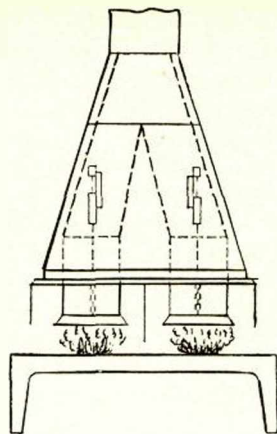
Hota de exhaustare cu țevi de aspirație glisante
